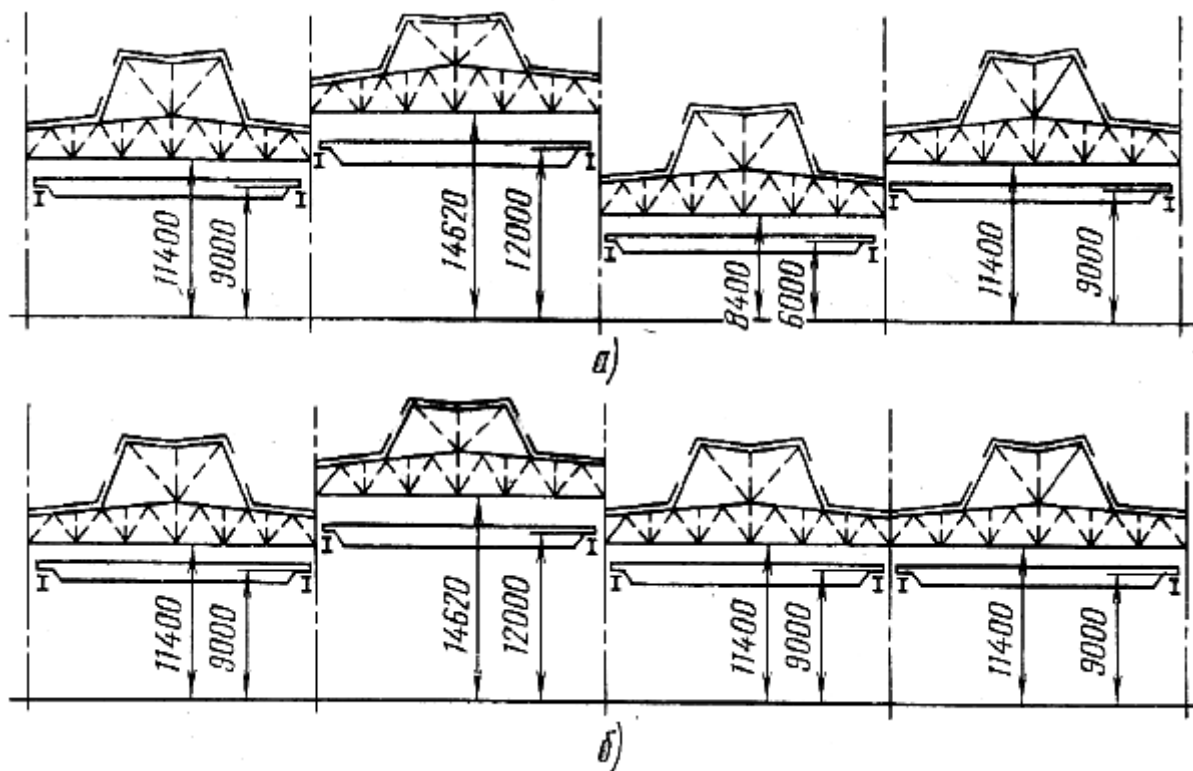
Поперечное сечение пролетов узловой сборки и сварки при планировке цеха со смешанным направлением производственного потока: *а* – неправильно; *б* – правильно
